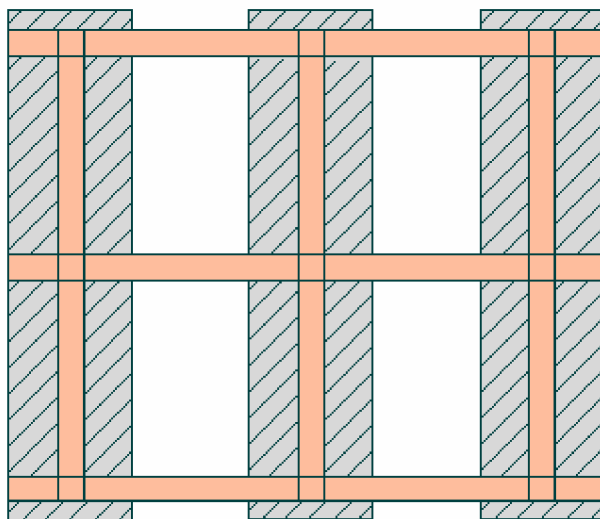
Alternativa de cimentación consistente en un sistema o entramado de zapatas continuas en dos direcciones.
